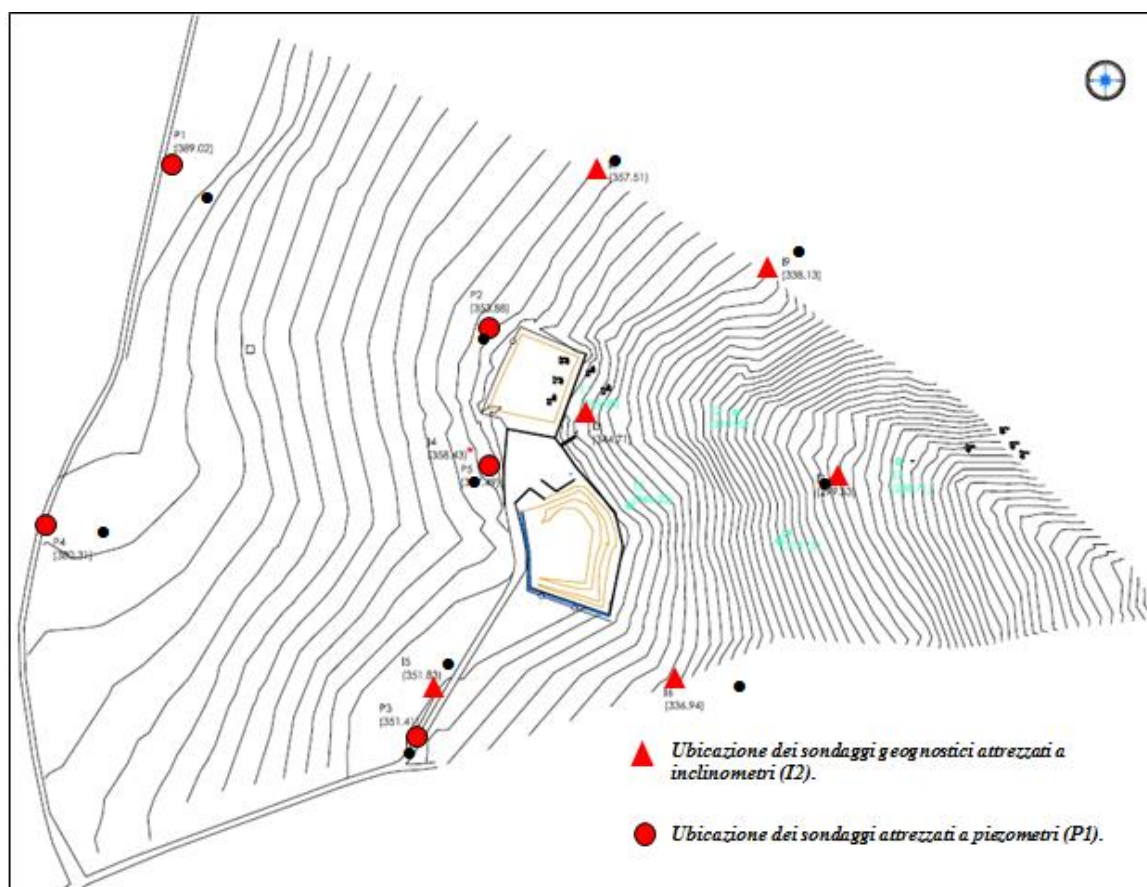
Stralcio planimetrico con ubicazione delle indagini geognostiche e piezometri.
